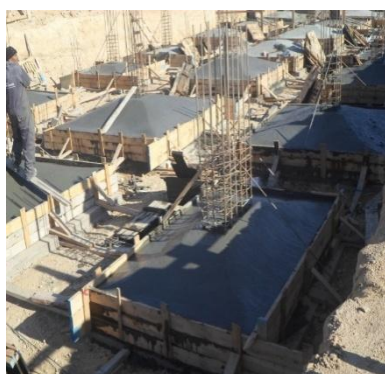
Ferrailage et coffrage de semelle carrée
